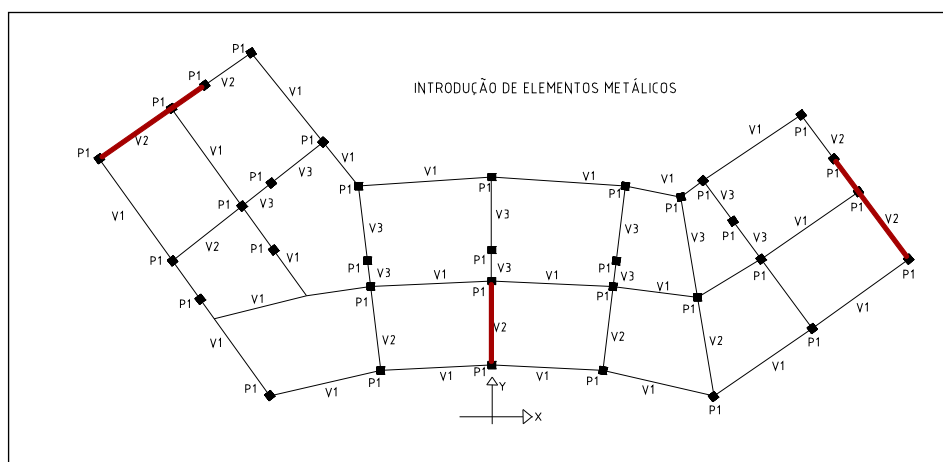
Planta estrutural do edifício reforçado com introdução de elementos metálicos.
